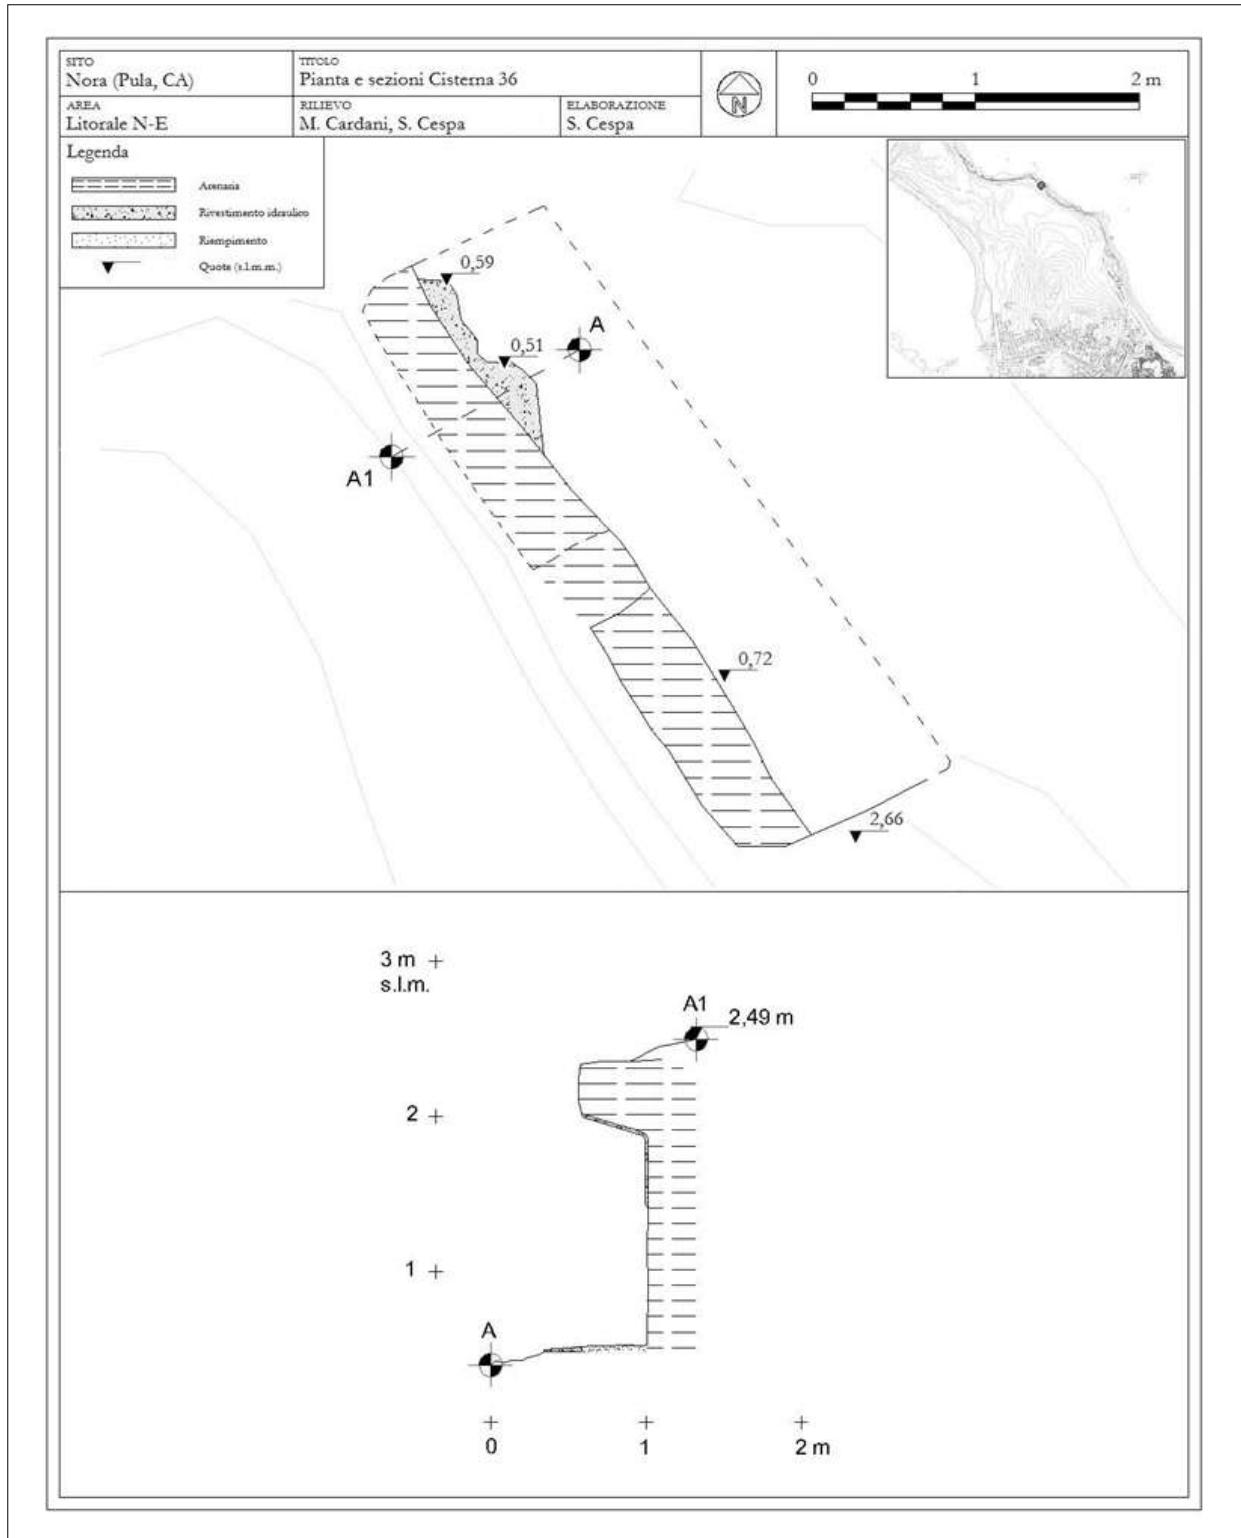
Pianta e sezioni della cisterna 36 (elaborazione dell'autore).
